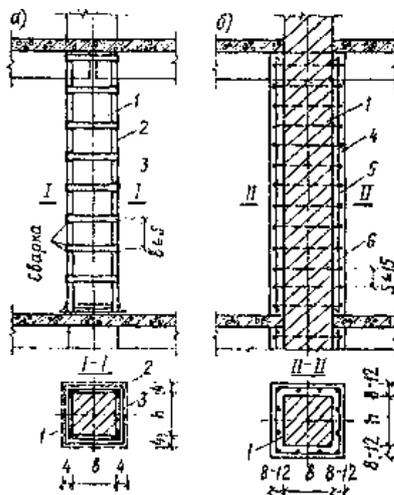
Усиление столбов стальными и железобетонными обоймами
